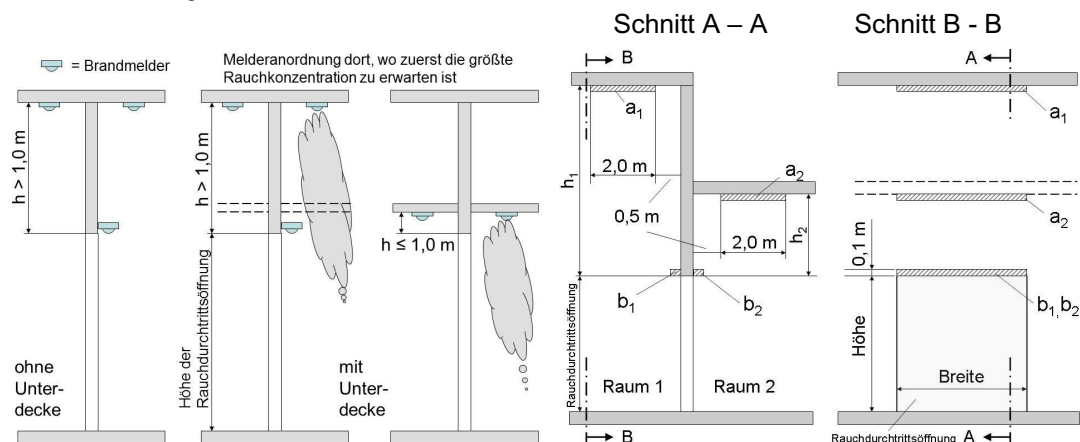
Maßgebende Höhe der Deckenunterfläche Bild 2: Installationsbereiche
